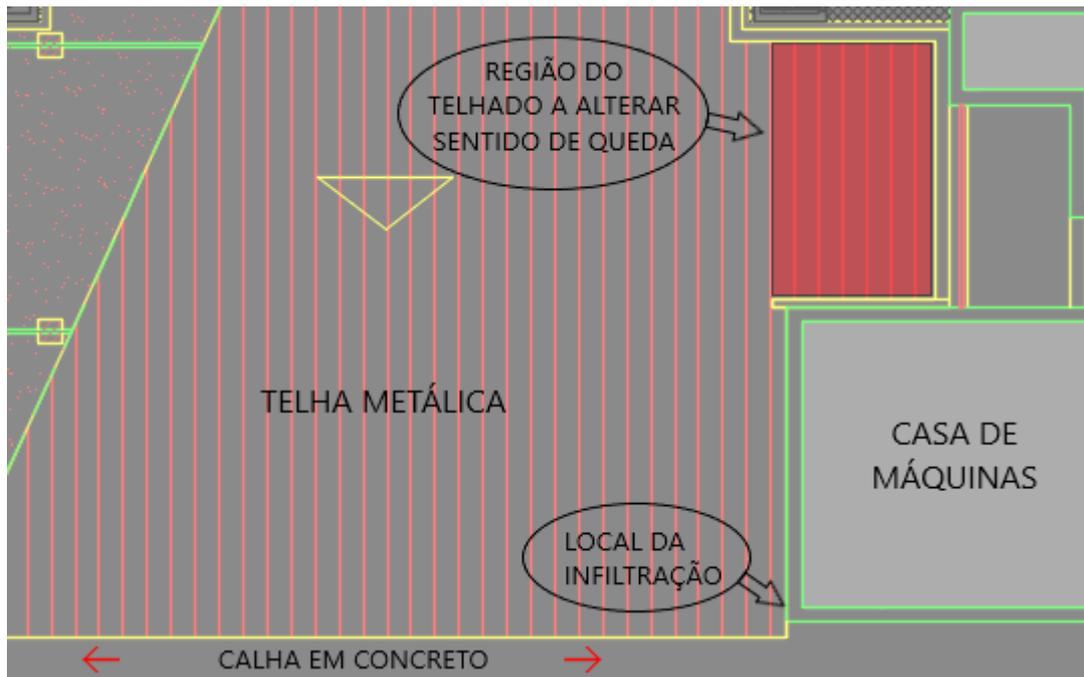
Indicativo de local da infiltração e região de mudança de queda do telhado.
